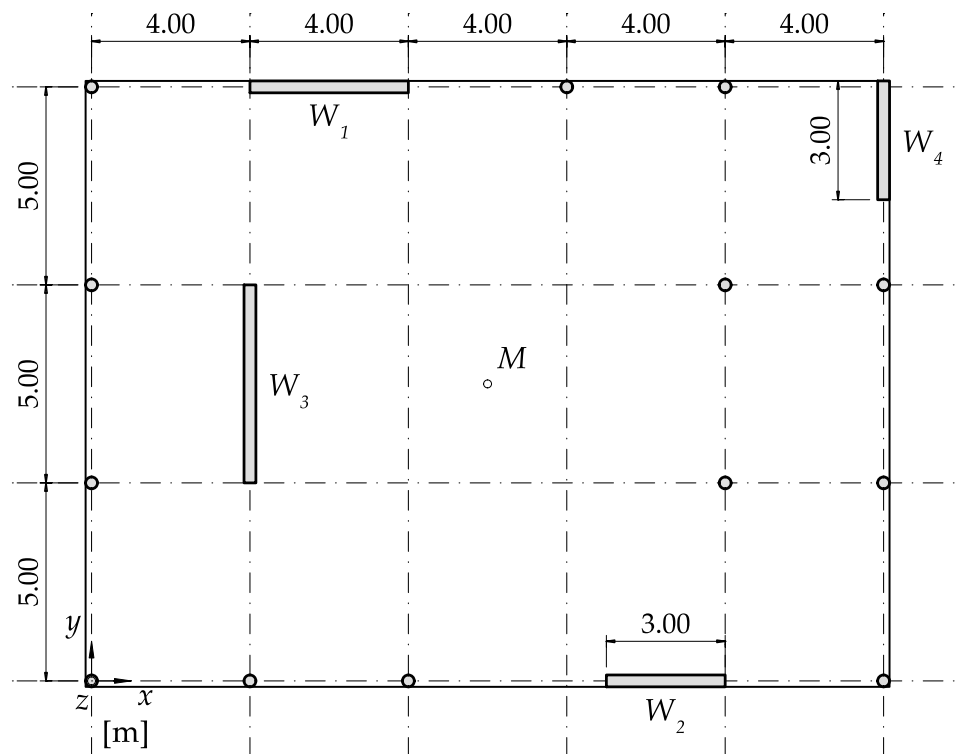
Grundriss des Gebäudes
